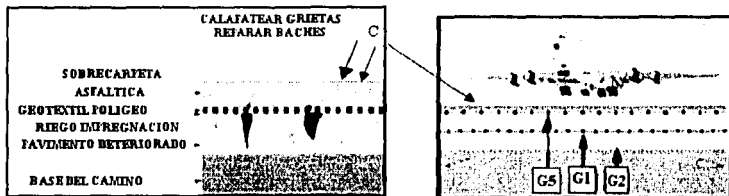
Los geosintéticos proveen el drenaje, la separación y el refuerzo requeridos para estabilizar la base de caminos (C pavimento rígido o flexible, G1 geomalla bi-orientada o mono orientada, G2 geocompuesto para el drenaje, G5 geomalla para refuerzo de asfalto ó geotextil como impermeabilizante)
